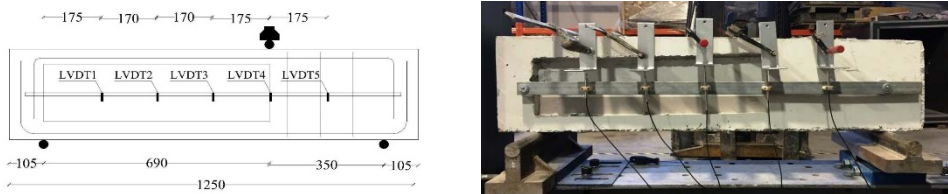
Proвете viga, *setup* de ensaio e posição dos LVDT's (dimensões em mm)
